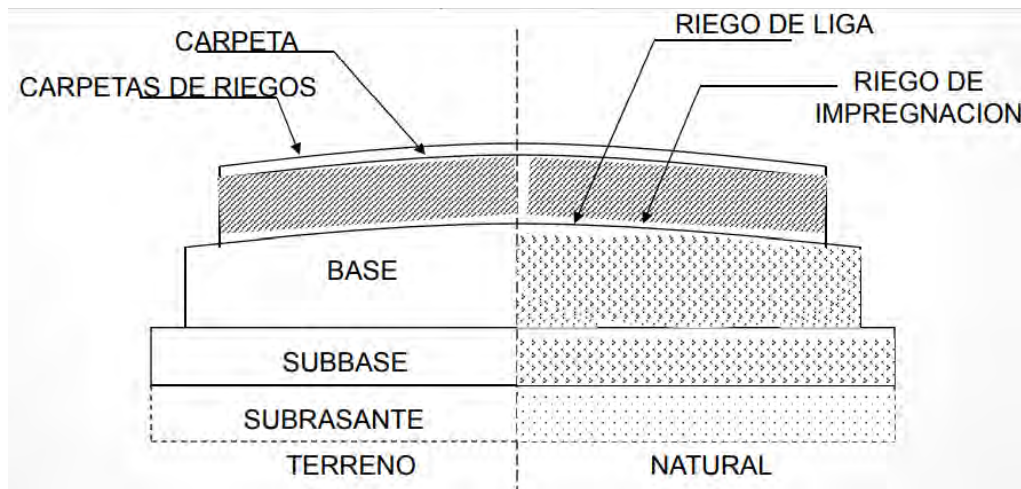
Esquema general de un pavimento flexible (Reyes R. R., 2020).
